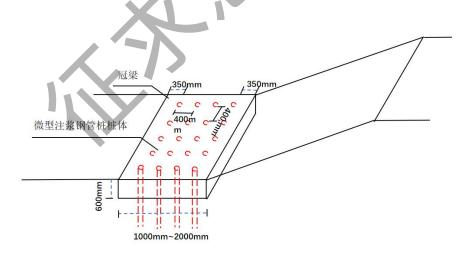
膨胀土边坡坡底冠梁布置示意图
